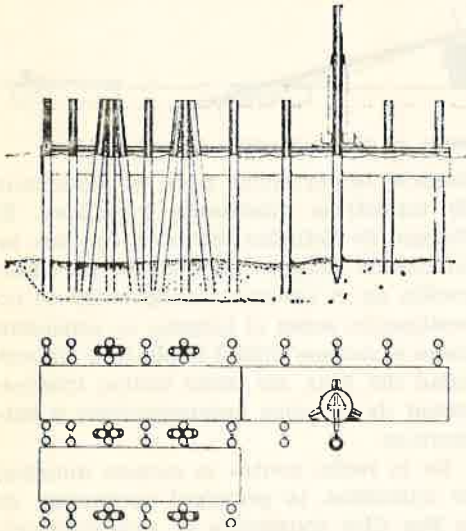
Dibujo de construcción que muestra la disposición de los pilotes y anclajes de elementos de hormigón armado
